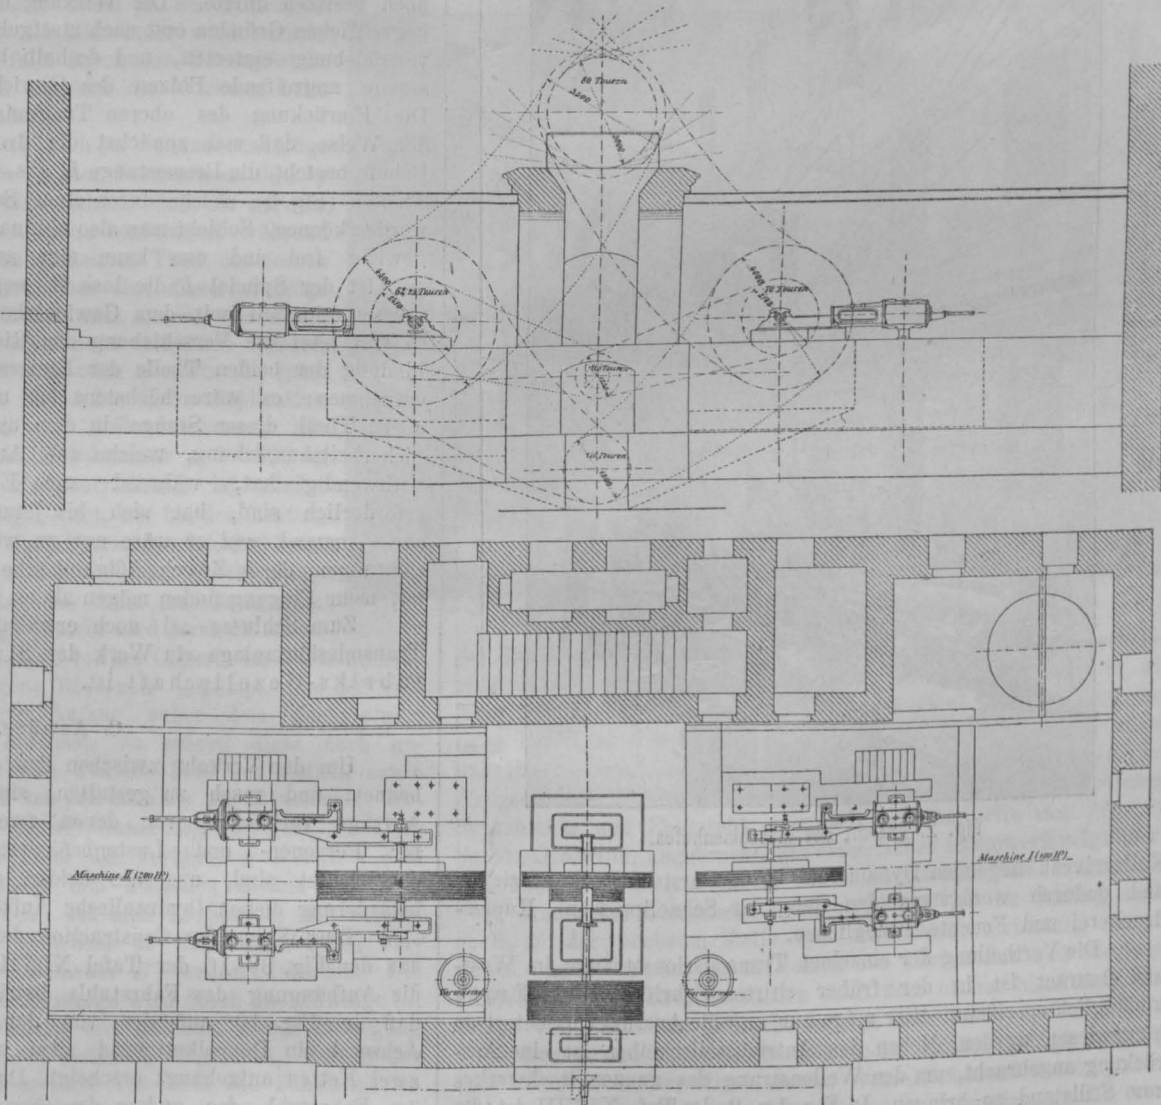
Aufriss und Grundriss des Maschinenhofes.
